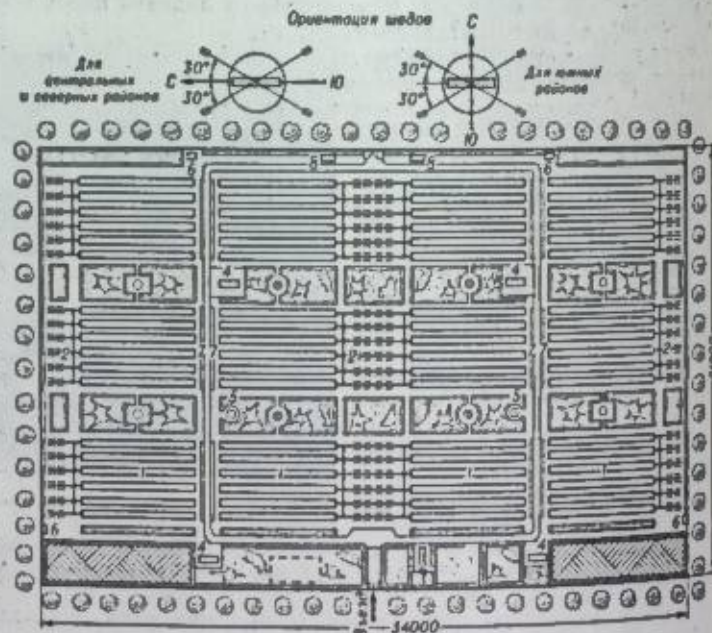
Типовая звероводческая универсальная ферма (генплан): 1 — шеды для основного стада или молодняка; 2 — клетки для самок лисц или песцов; 3 — служебное здание; 4 — сарай для инвентаря; 5 — пожарный резервуар; 6 — уборная; 7 — площадка для разгрузки бачки с кормами; 8 — площадка для сбора контейнеров с экскрементами.
